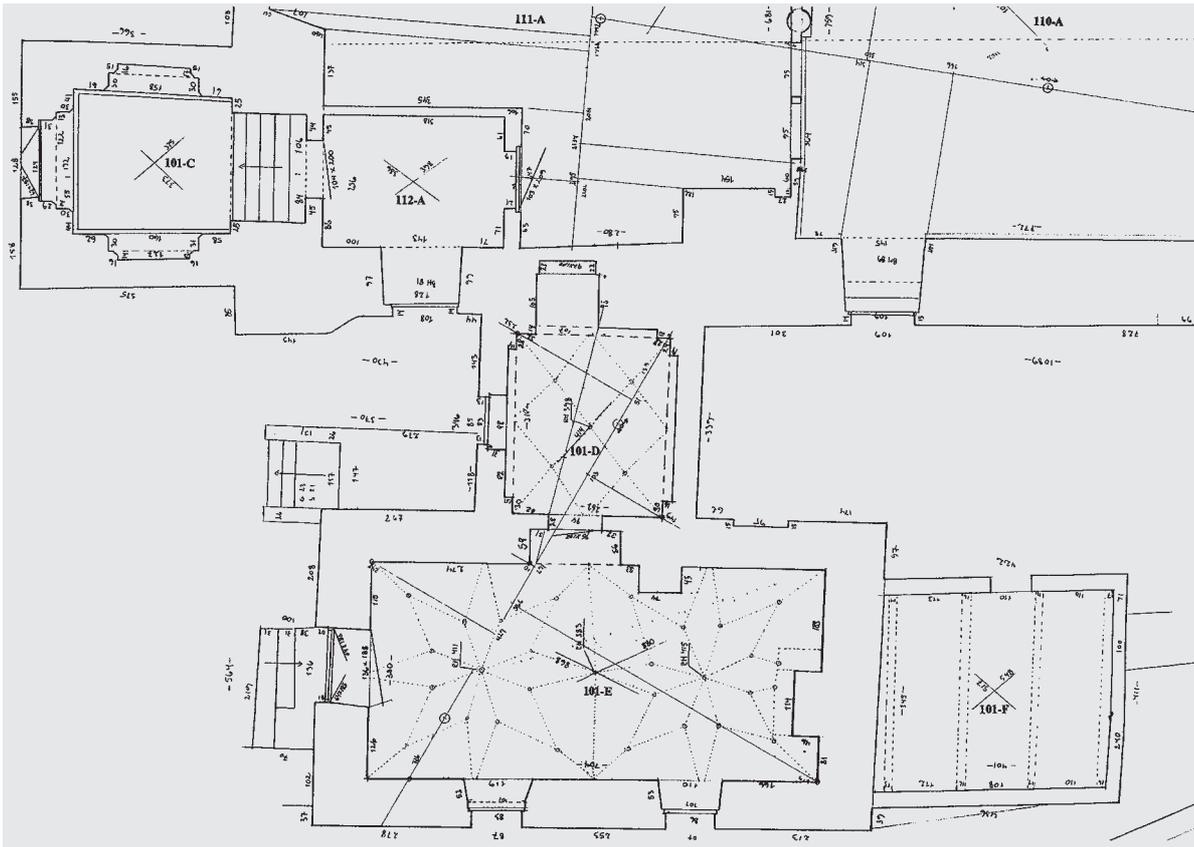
Detailgrundriss eines gerätegestützten Handaufmaßes in Genauigkeitsstufe III, Maßstab 1:50
